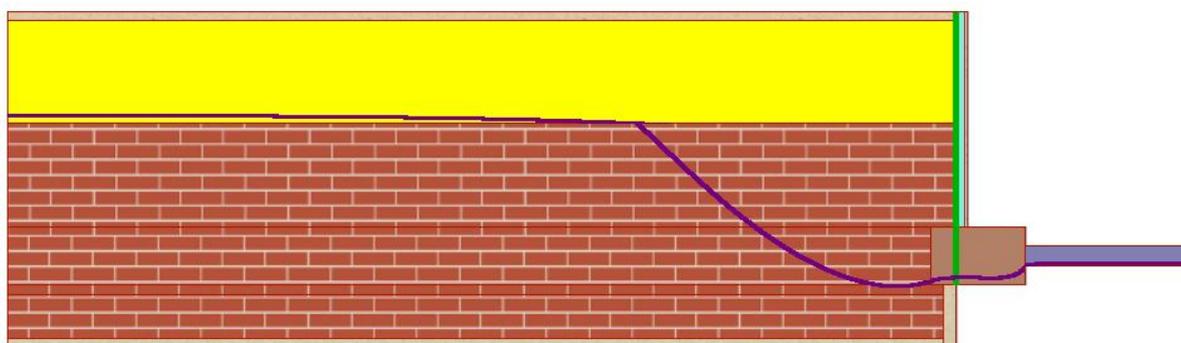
Andamento dell'isoterma del rischio formazione muffa con spalletta corretta
